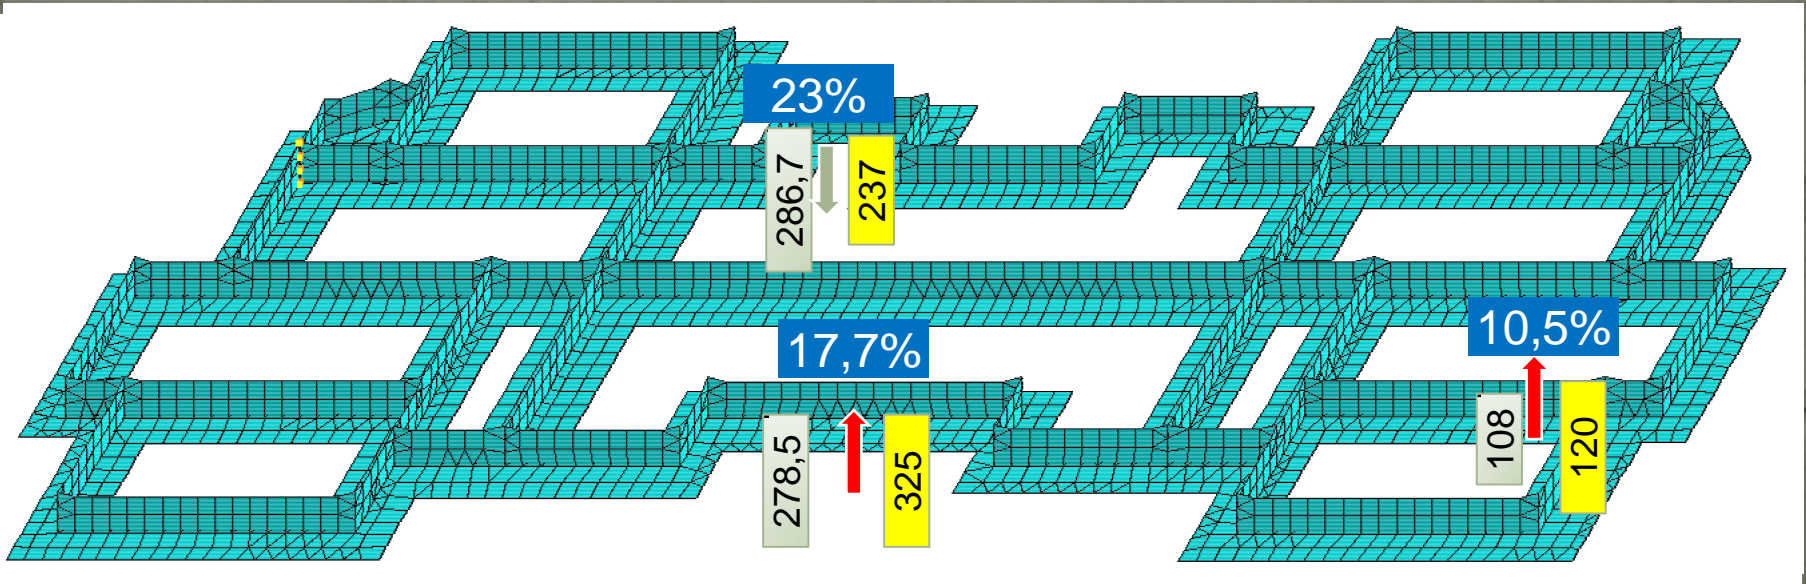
Картина перерозподілу поздовжніх сил в колонах будівлі з врахуванням реальної роботи основи
